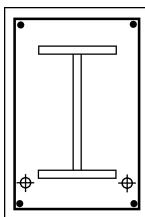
1 预应力型钢混凝土梁的型钢截面配筋形式
